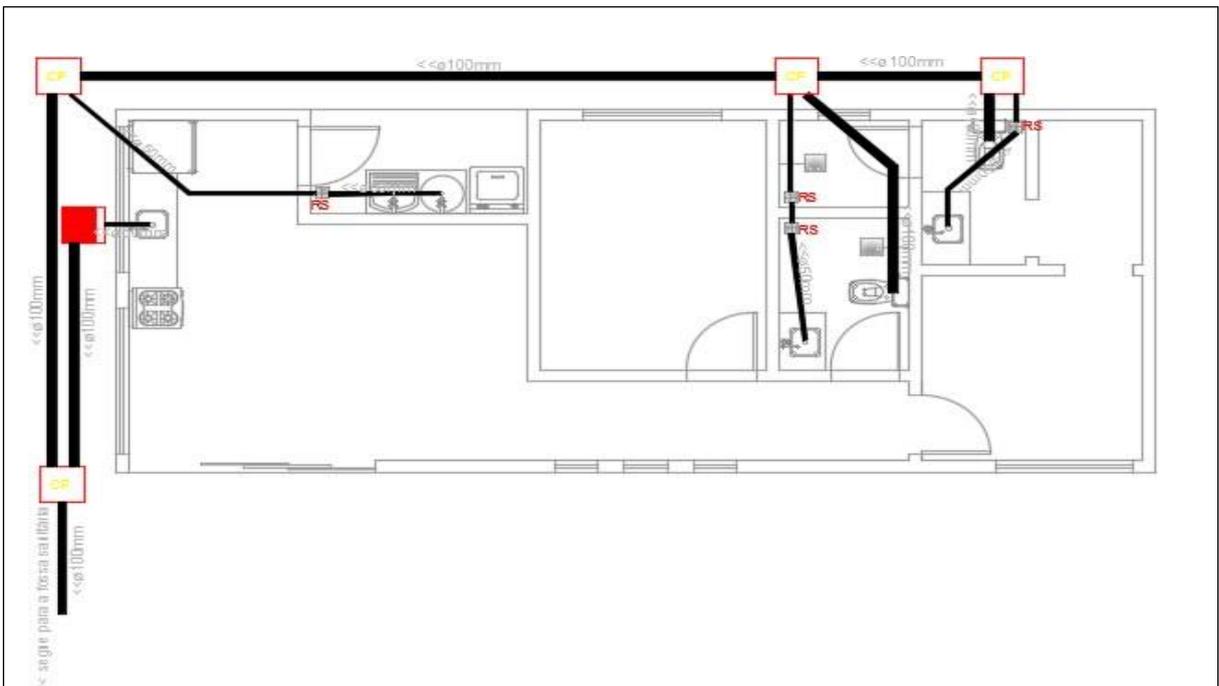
Projeto instalação esgoto construção convencional/Contêiner
